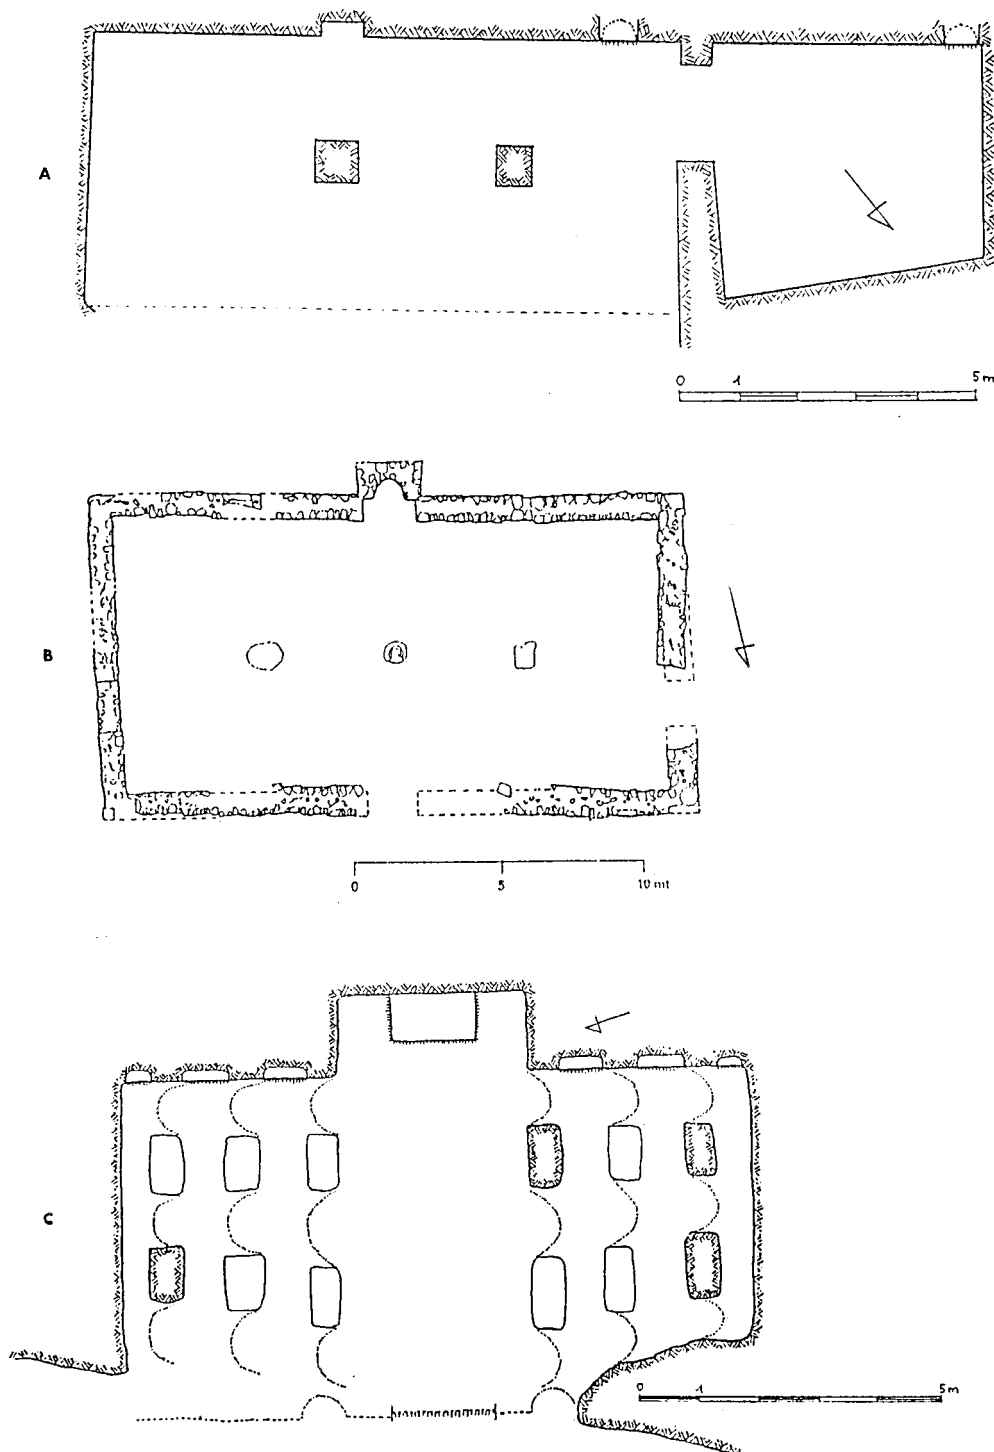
a) Planimetria della moschea rupestre del Balzo della Rossa a Sperlinga; b) planimetria della moschea di Segesta; c) planimetria della moschea rupestre di Rometta.
